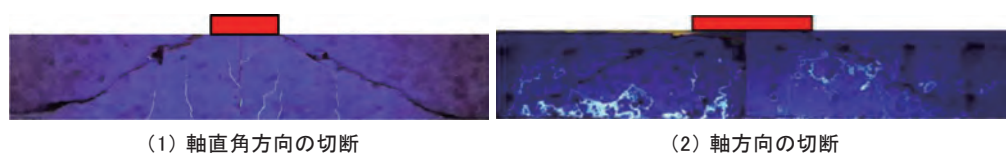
ひび割れ補修による接着剤の浸透状況
